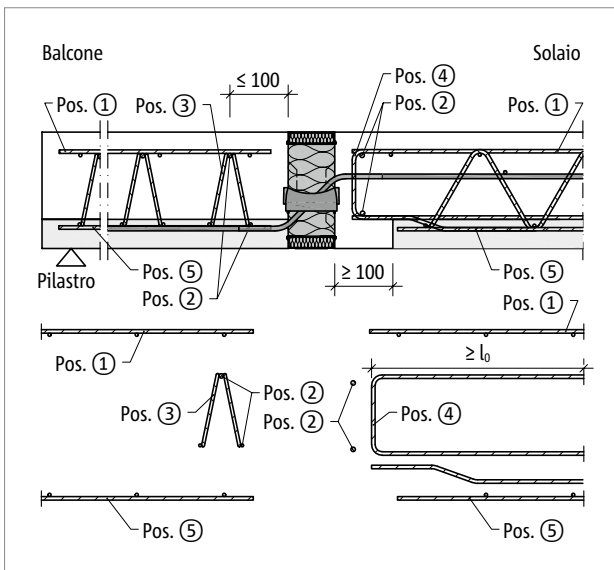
Schöck Isokorb® T tipo Q-V5 – Q-V10: armatura in opera con traliccio di supporto
